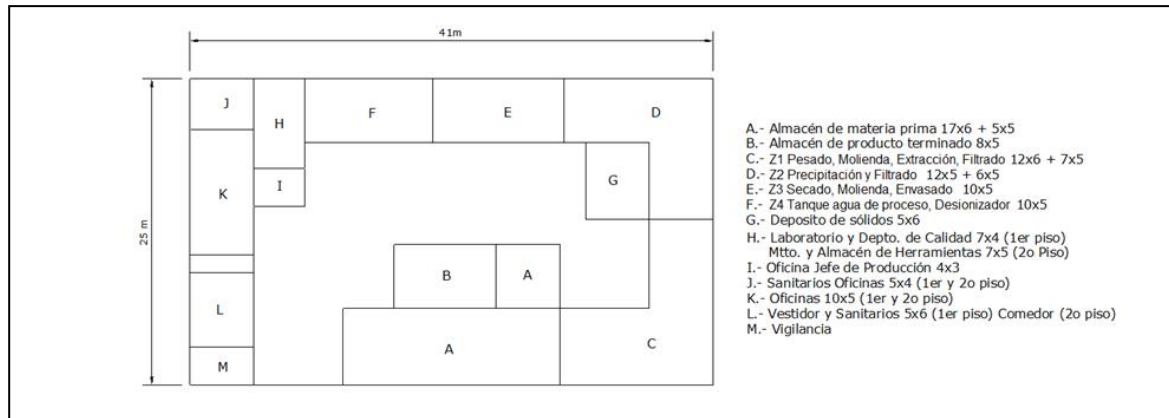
LayOut de la planta de proceso (basado en Pérez M. A. 2014).
